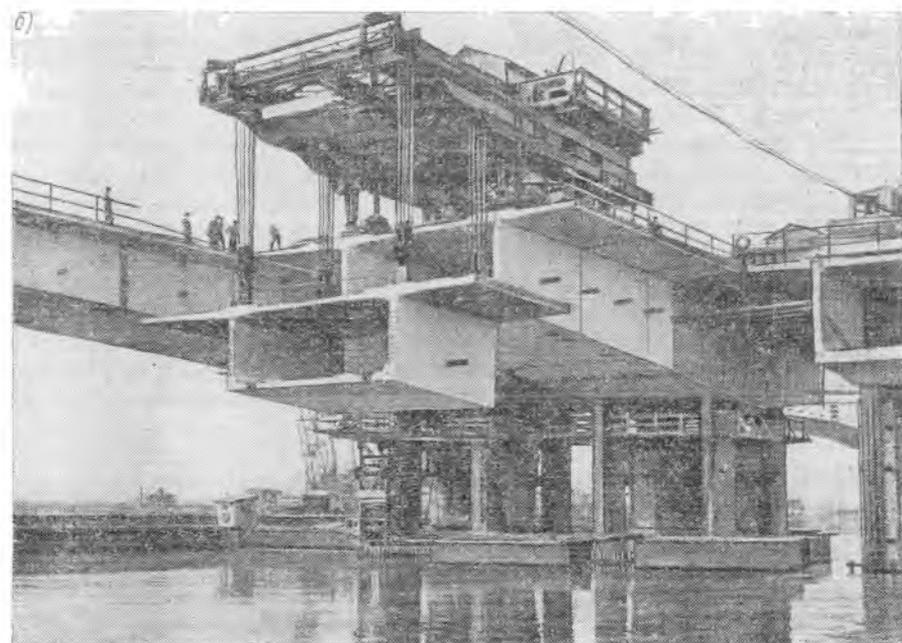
Навесной монтаж железобетонных пролетных строений:
